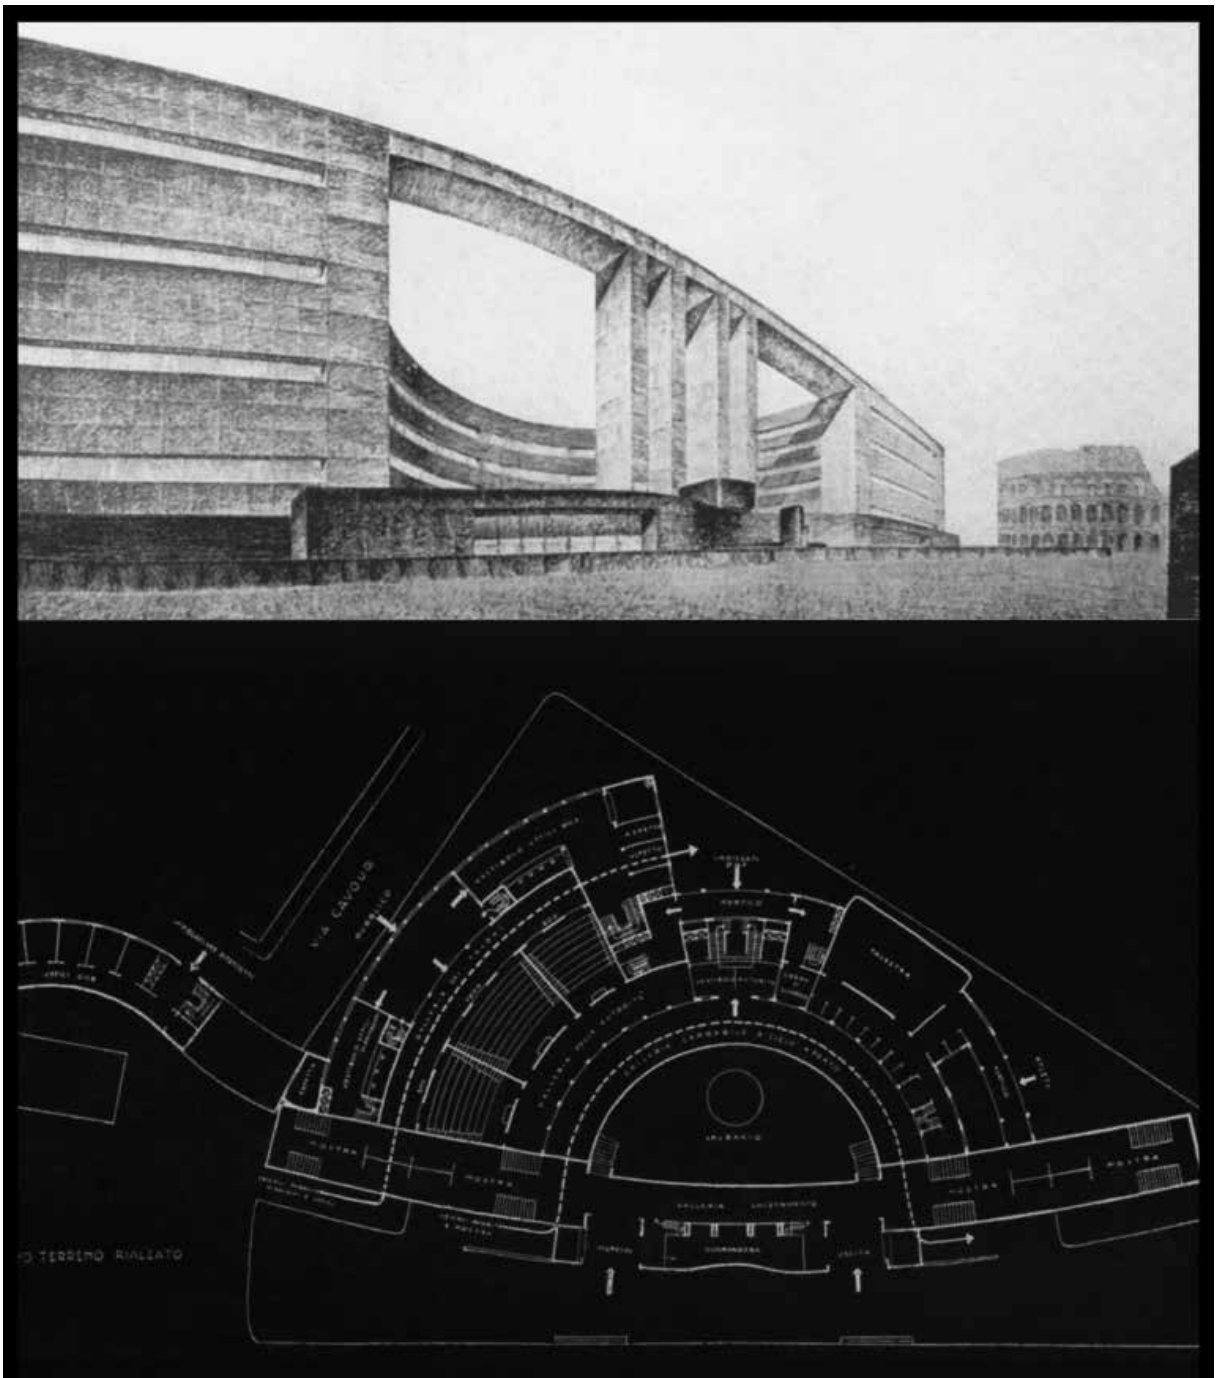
Progetto per il Palazzo Littorio di Giuseppe Samonà, vista prospettica, prospetto, pianta del piano terreno.
